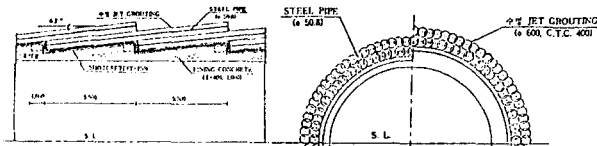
수평 Jet Grouting 시공 확폭 단면
